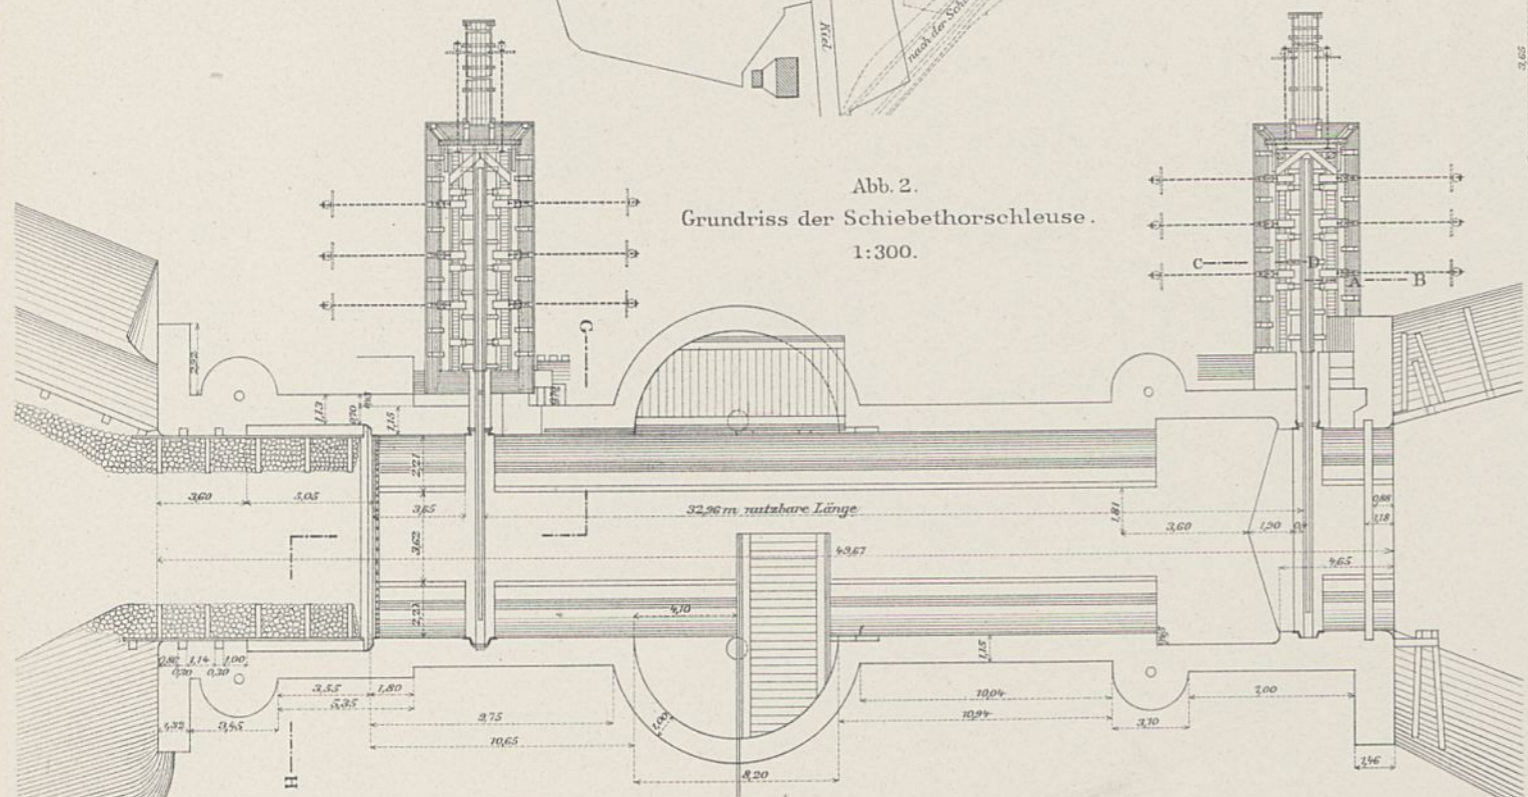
Grundriss der Schiebethorschleuse. 1:300.
